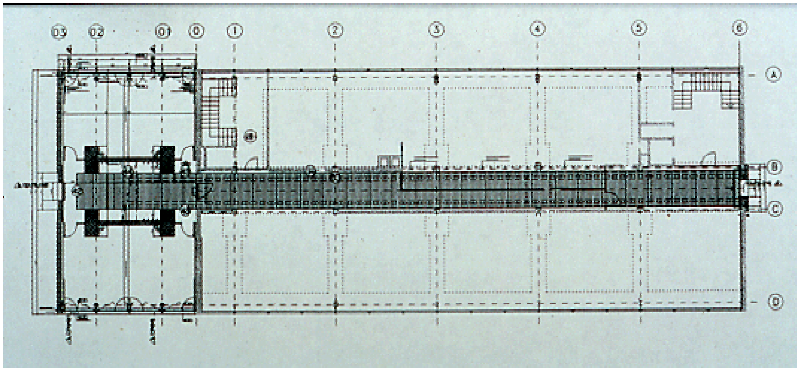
Grundriss des verlängerten Polizeigebäudes mit den beiden kapazitätsbemessenen neuen Stahlbetontragwänden
